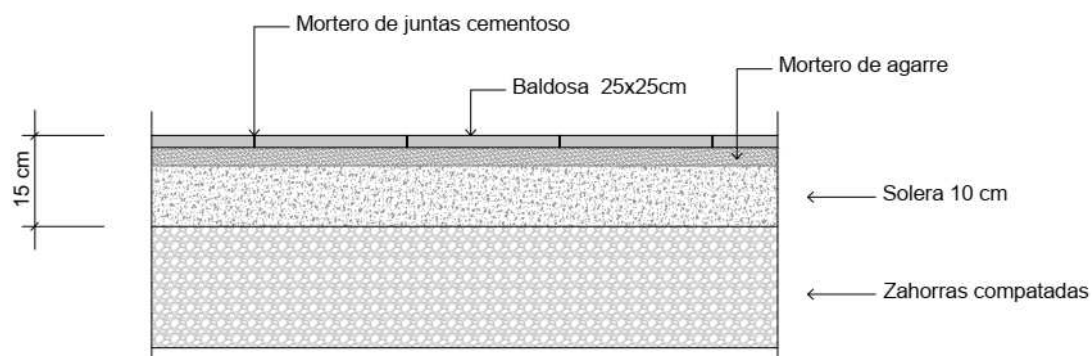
Detalle sección constructivo cimentación. Fuente propia programa AutoCAD
